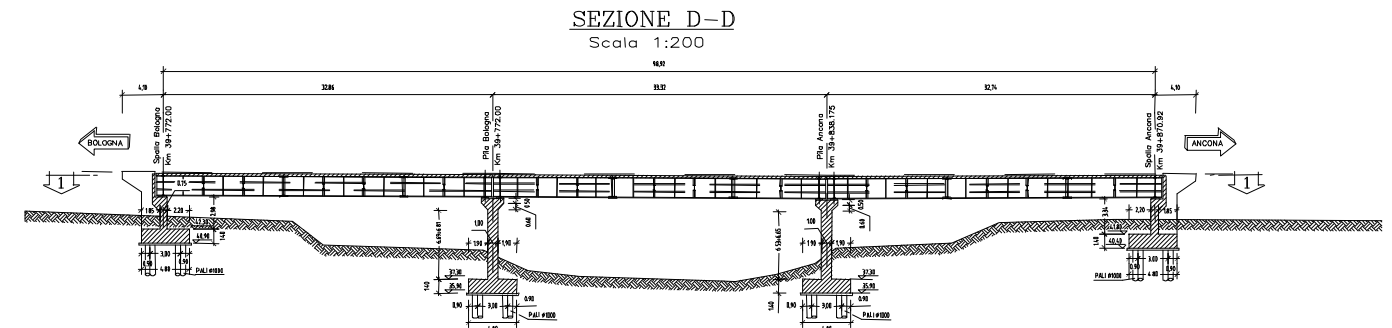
Ponte sul Torrente Sillaro - Sezione longitudinale su struttura ampliata
